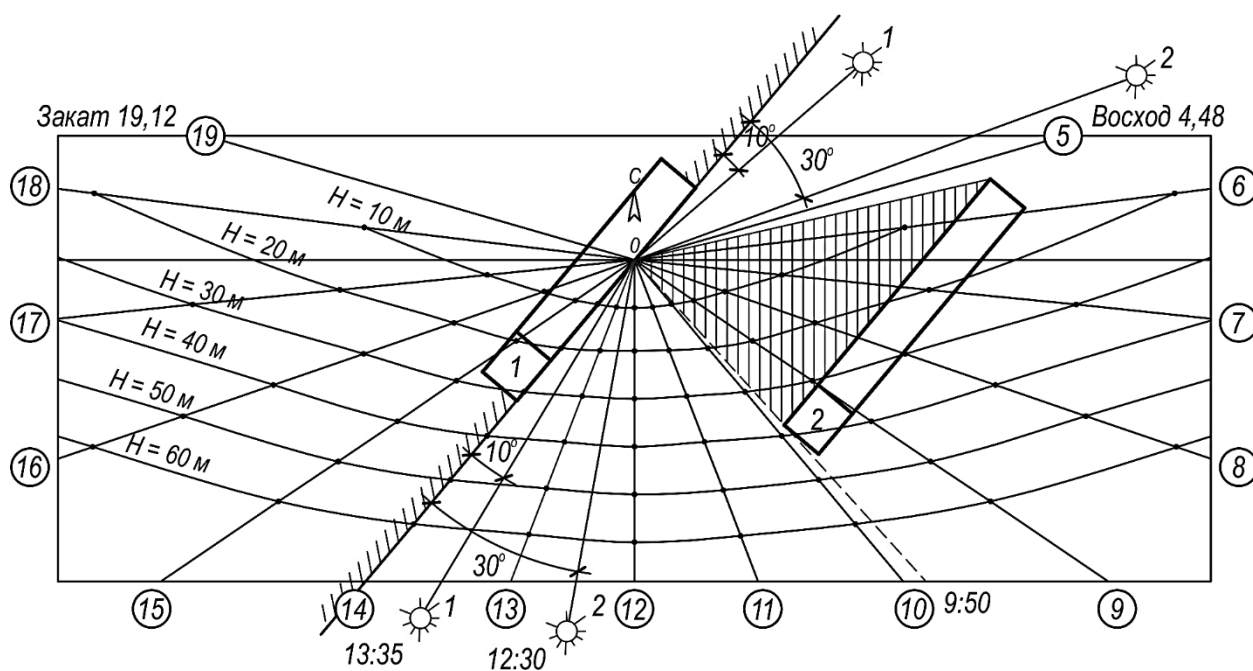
Схема к определению продолжительности инсоляции помещения в здании № 1, расположенного вблизи здания № 2
